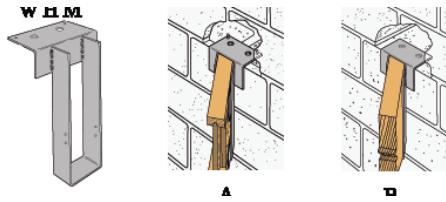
Подпиране на греда към зидария: А – начин на подпиране на прекъсната ПДГ от стена иззидана от газобетон посредством опорно устройство JHMS; В – подпиране на ПДГ в газобетонна стена чрез опорно устройство JHMR;
